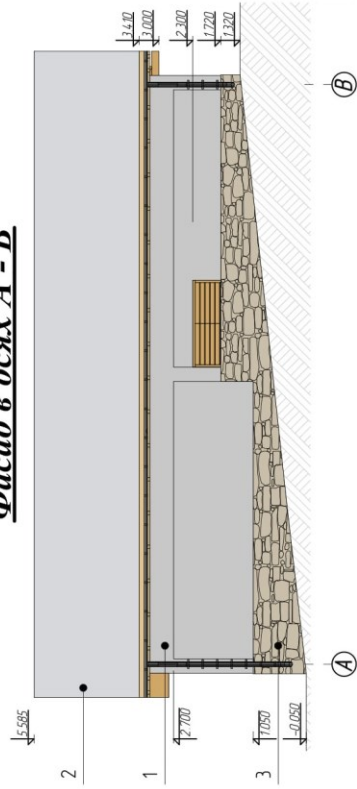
Фасад А-В, В-А, 1-3, 3-1
